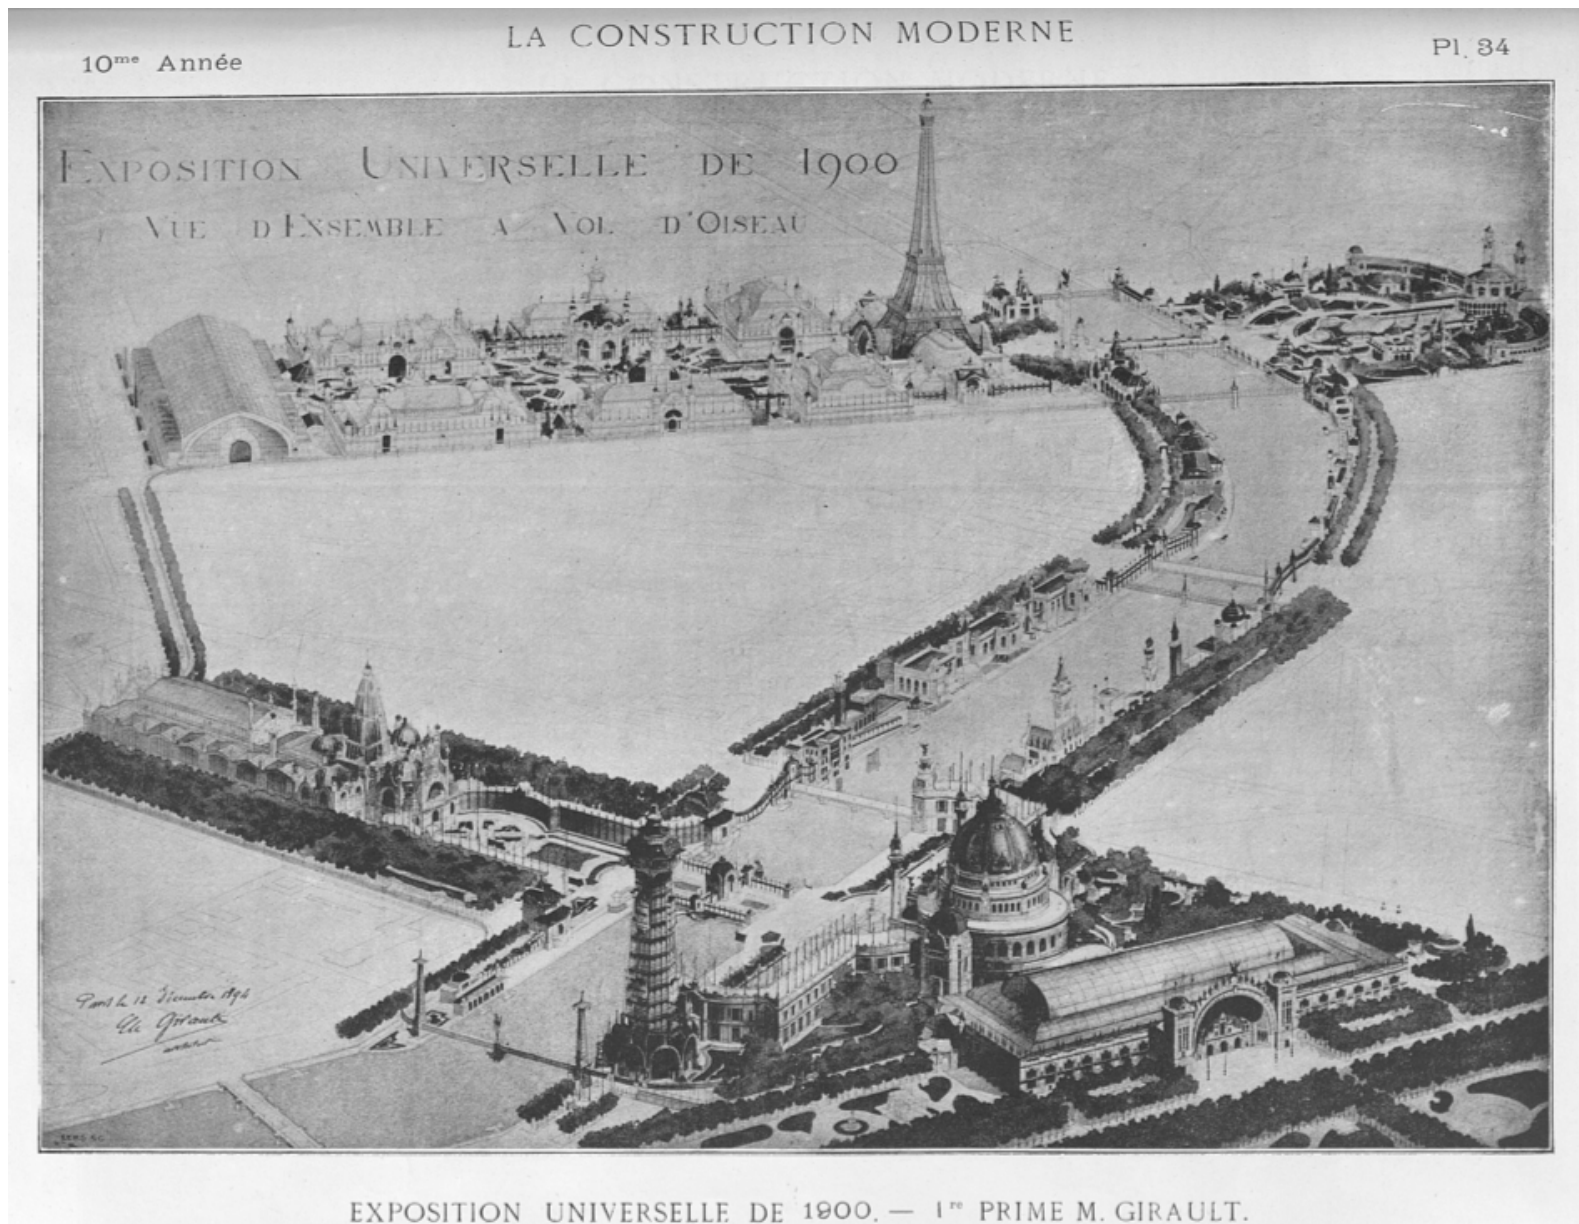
Exposition Universelle de 1900. 1<sup>er</sup> Prime: M. Girault. (Fonte: La Construction Moderne, CM-1895-01-RAPPORT DE M. GUADET [cont.], 1895)
